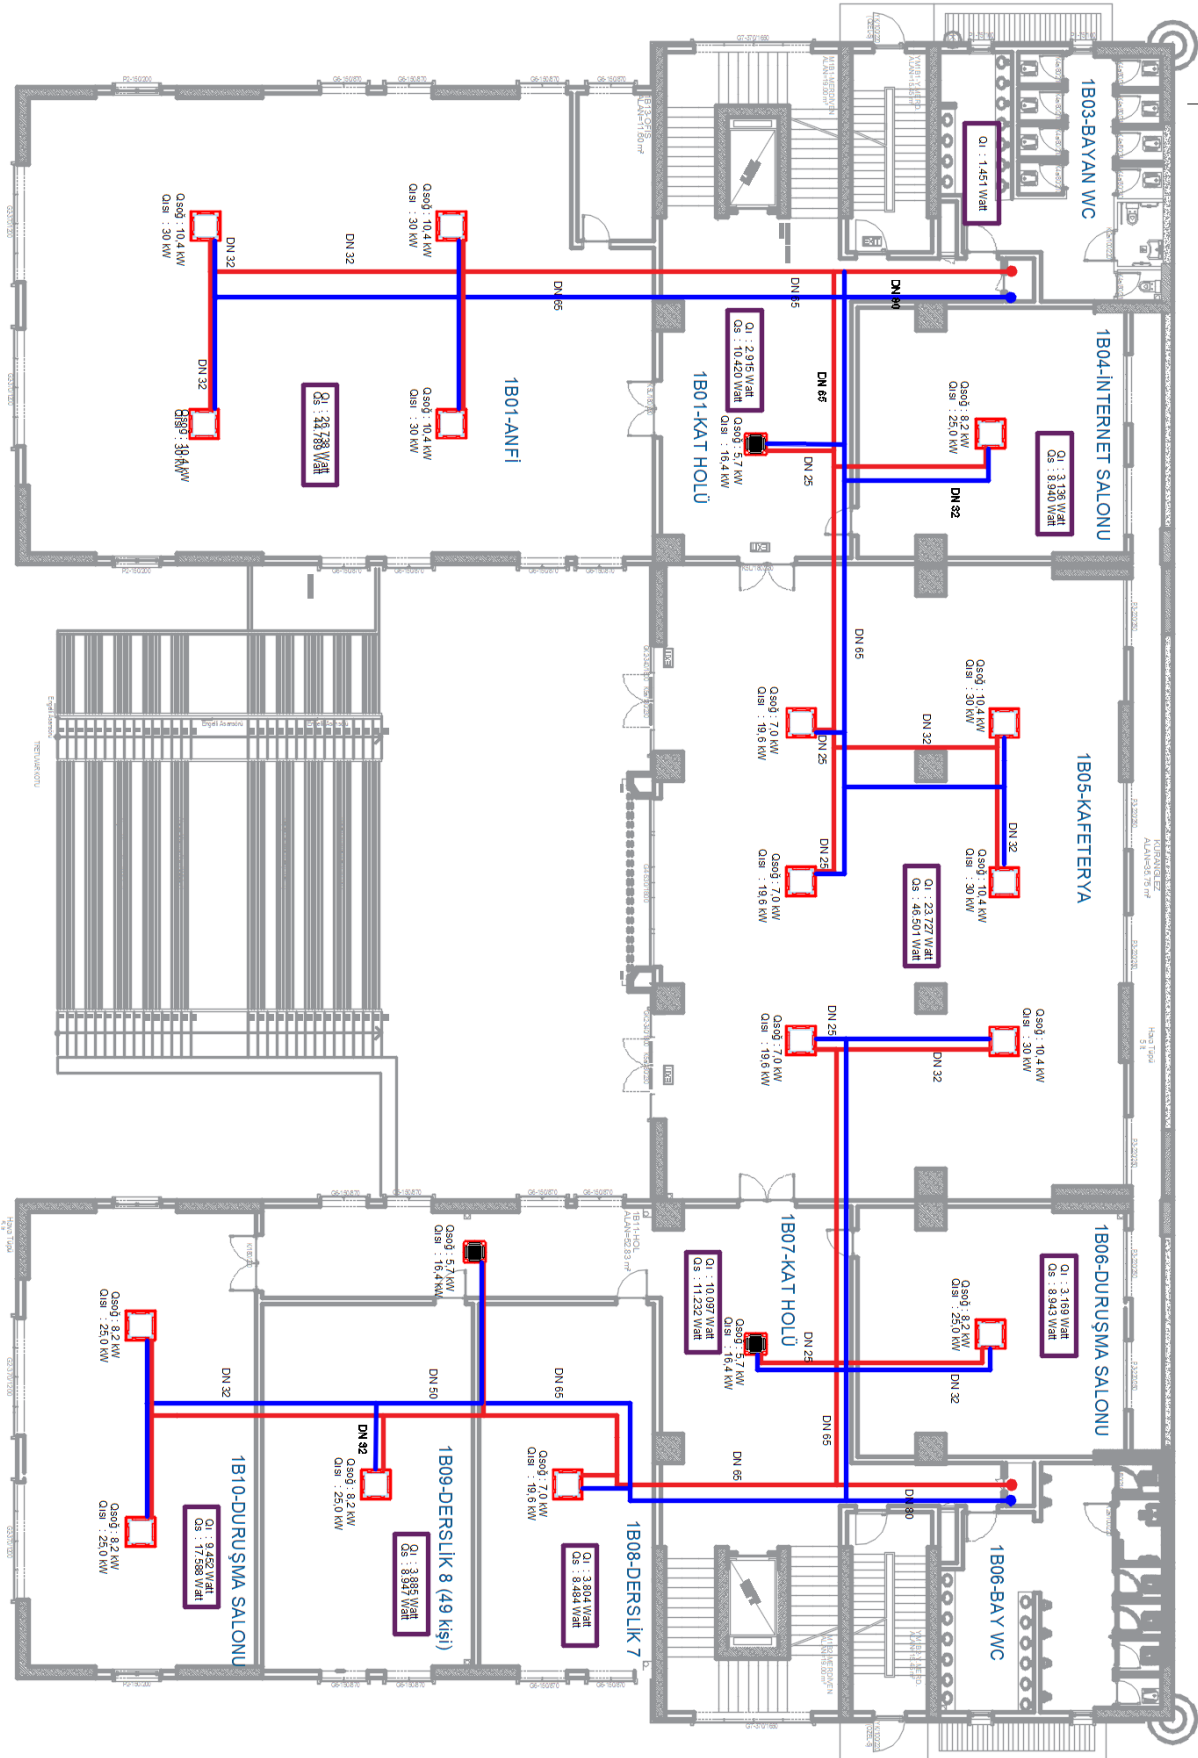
VRF tesisatı Sistem 4 grubuna ait kolon şeması.
